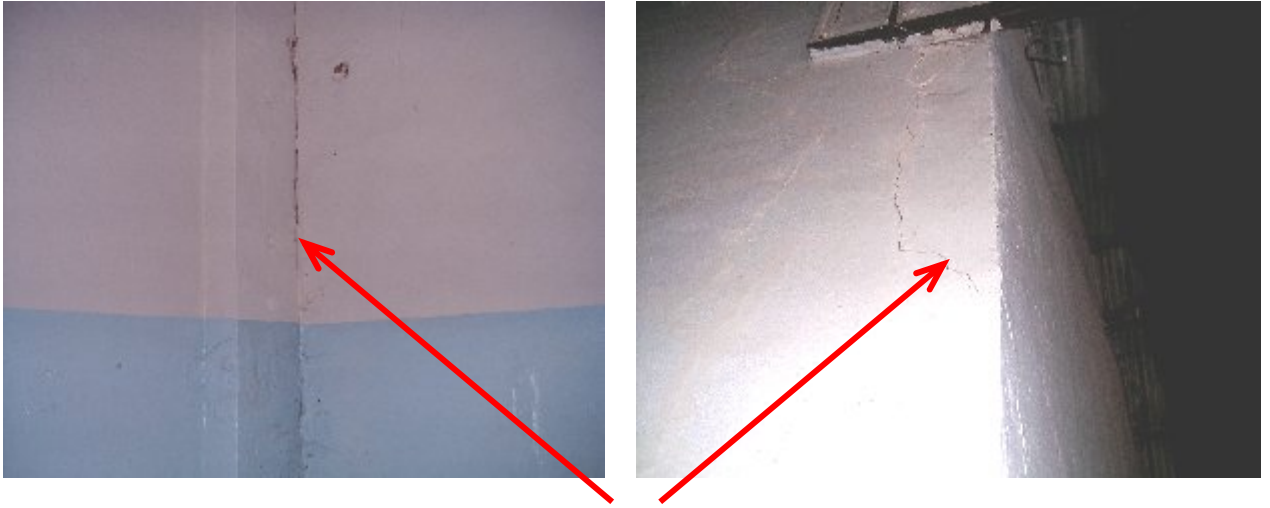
Présence de fissurations dans les murs.
